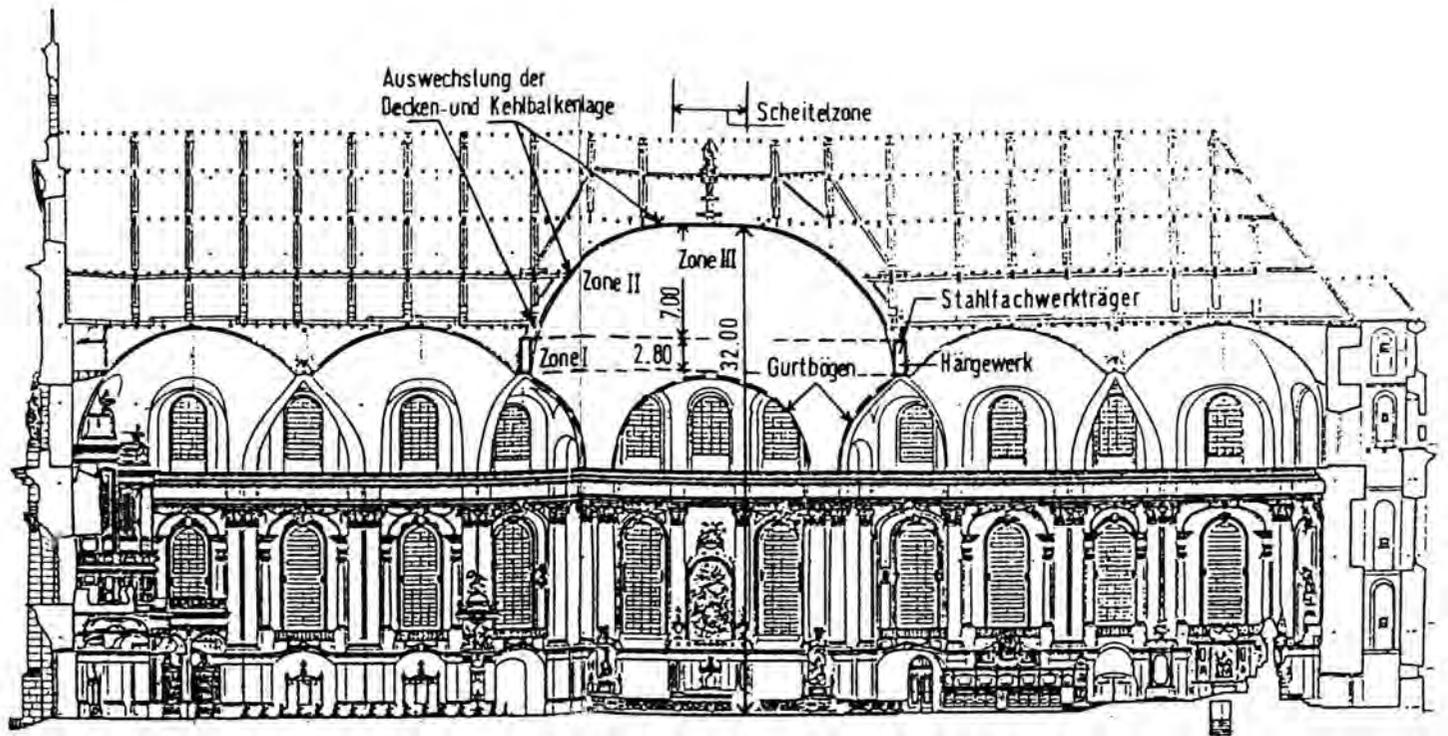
Abtei Neresheim, Längsschnitt mit Dachkonstruktion, aus /48/
